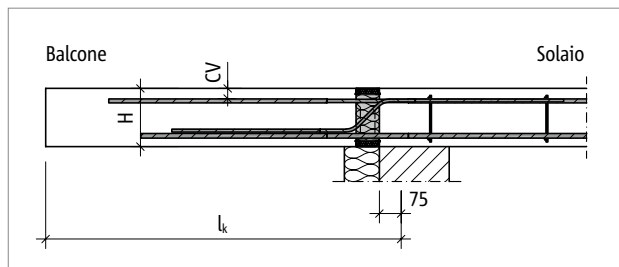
Schöck Isokorb® T tipo K-M13 – M14: schema statico
